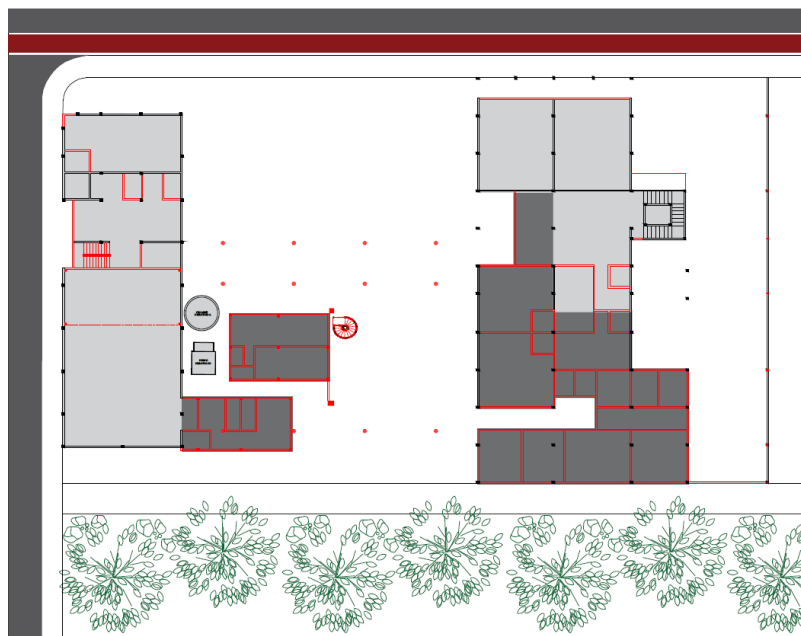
Planta baixa reforma | 1º Pavimento - Proposta
